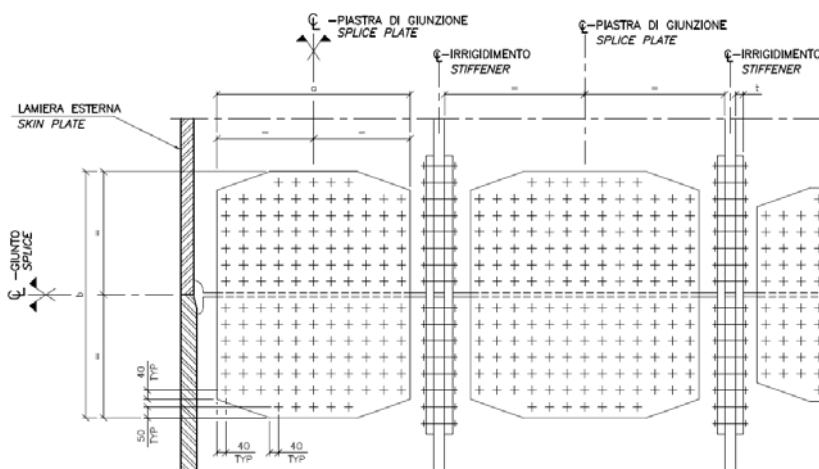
Dettaglio giunzione del piatto interno tipico.
